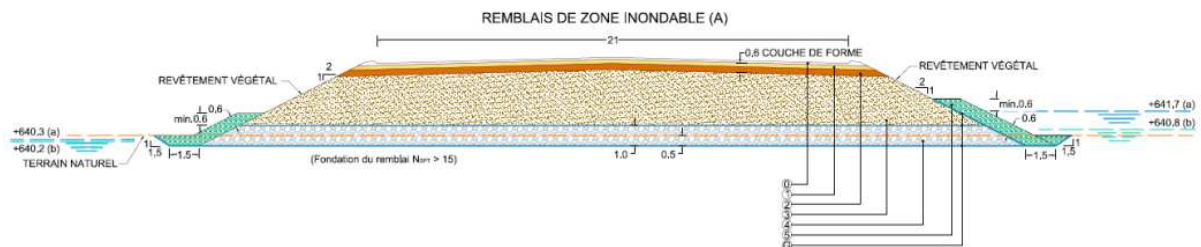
Profil type du remblai de zone inondable (A) du (PK 18+650 u PK 19+900) [2]
